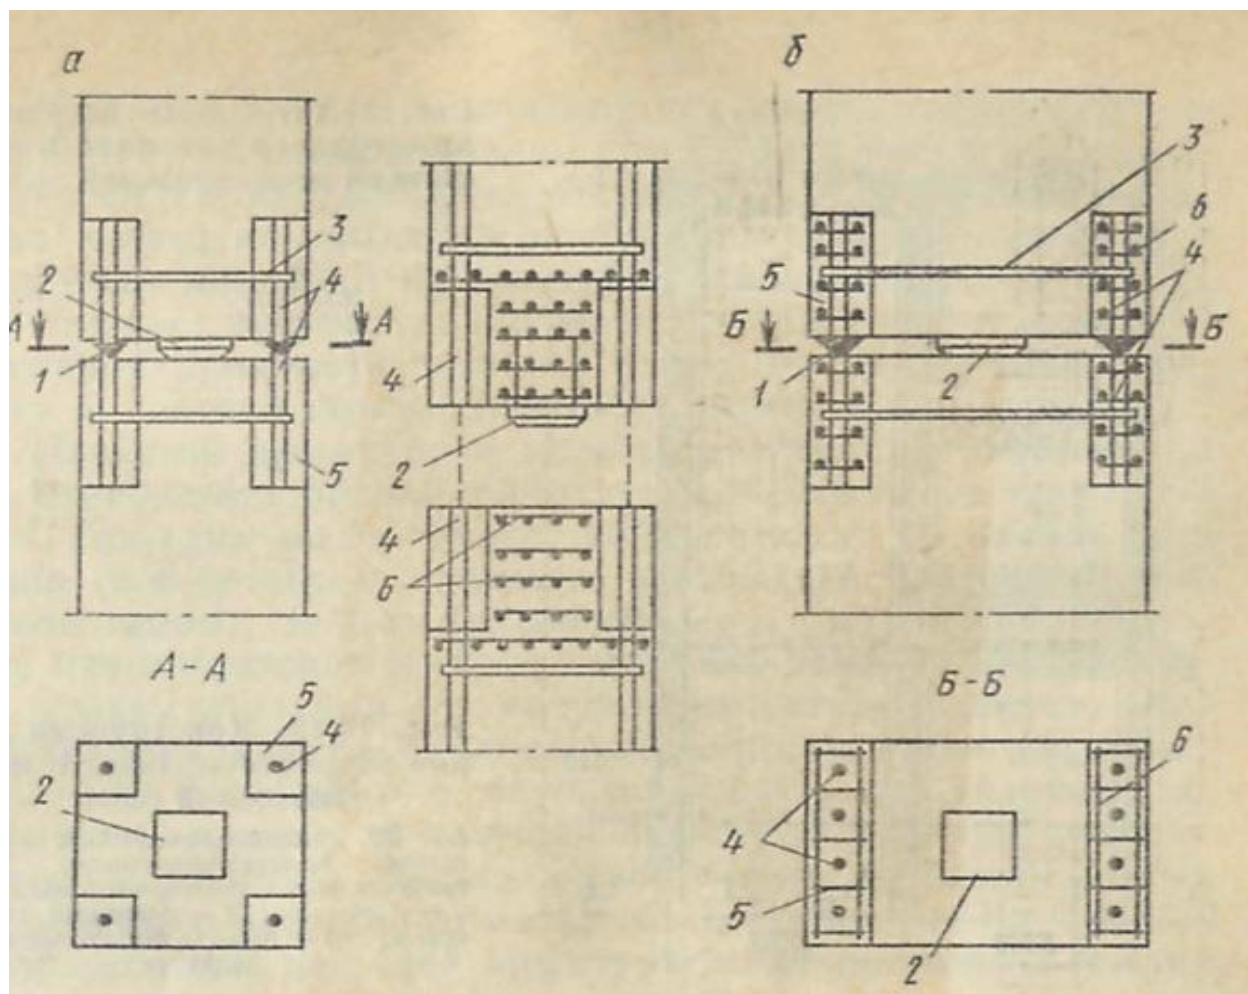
Конструкция жесткого стыка колонн с ванной сваркой арматурных выпусков
